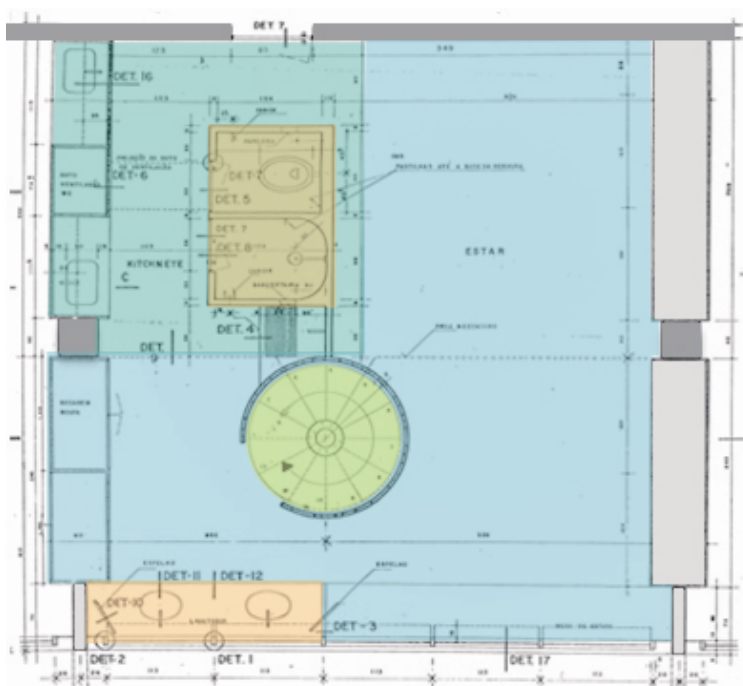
Alojamento UnB – Planta Pavimento Inferior da Unidade
